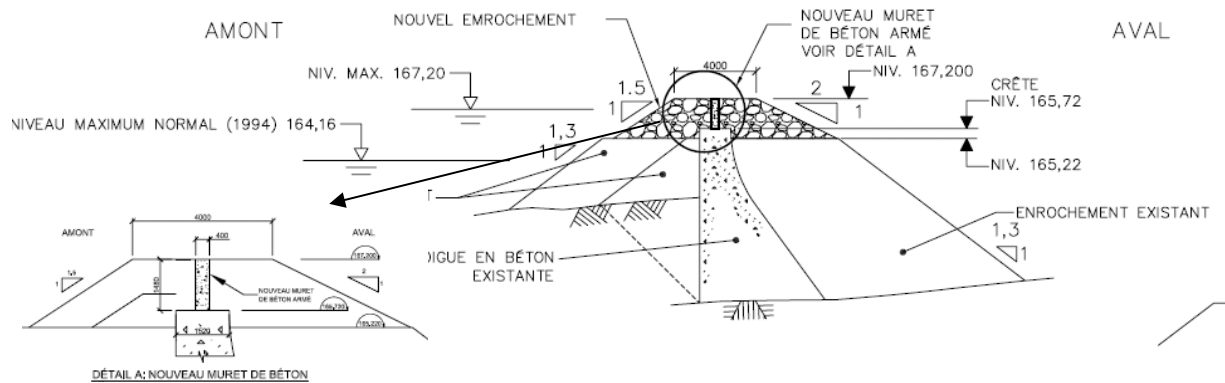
Travaux typiques projetés pour le rehaussement de la digue Creek Outlet-1
